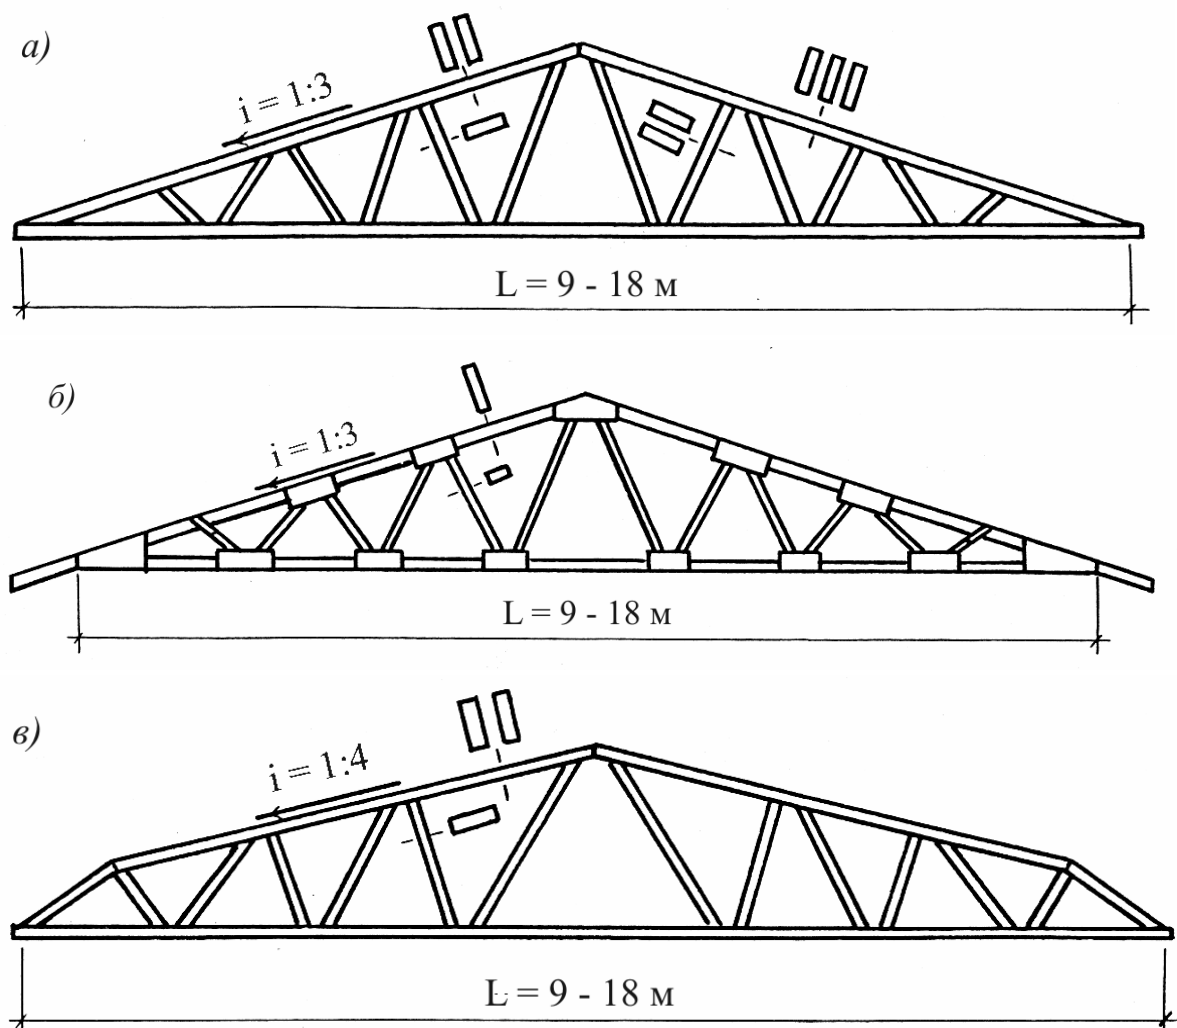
Дощатые фермы с узлами на клеевых соединениях: а – с бесфанерными узлами; б – с фанерными накладками; в – с арматурными сетками в узлах
